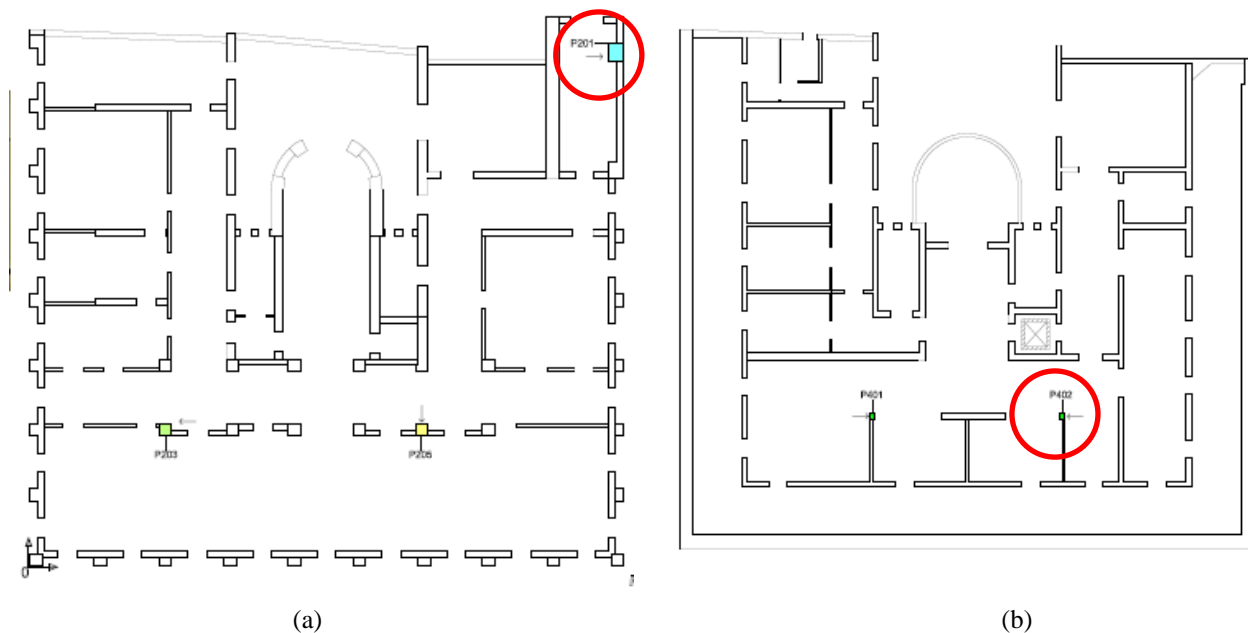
(a) Pianta chiave con indicazione dei punti di effettuazione delle battute sclerometriche sui pilastri al secondo e al quarto piano (P201 e P402 rispettivamente).
